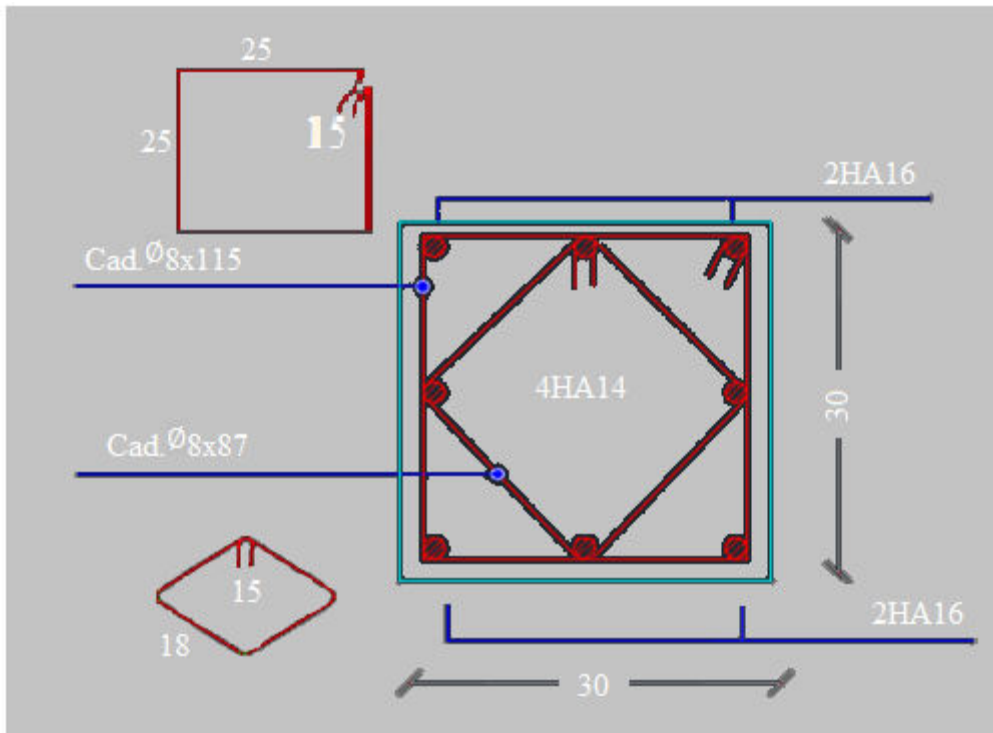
Coupe de ferrailage des poteaux 30x30 cm<sup>2</sup>
